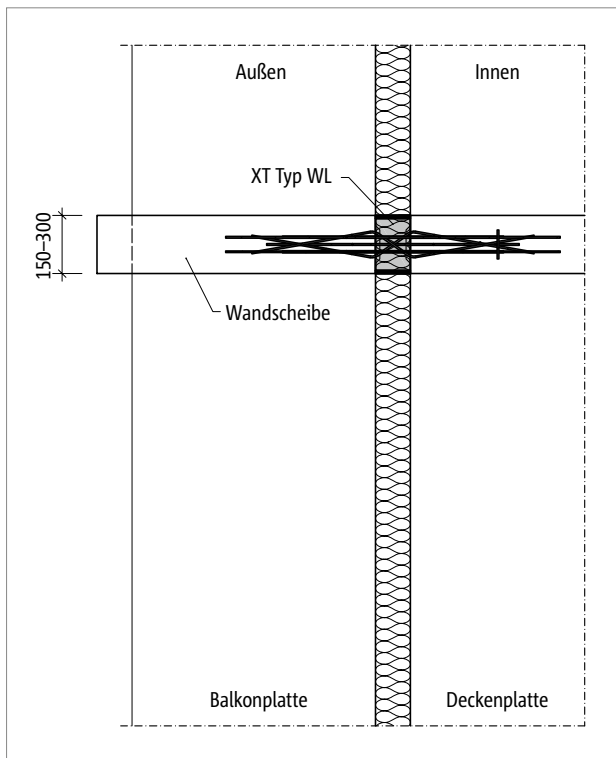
Schöck Isokorb® XT Typ WL: Grundriss; Balkonkonstruktion mit wärmegeämmten tragenden Wandscheiben
